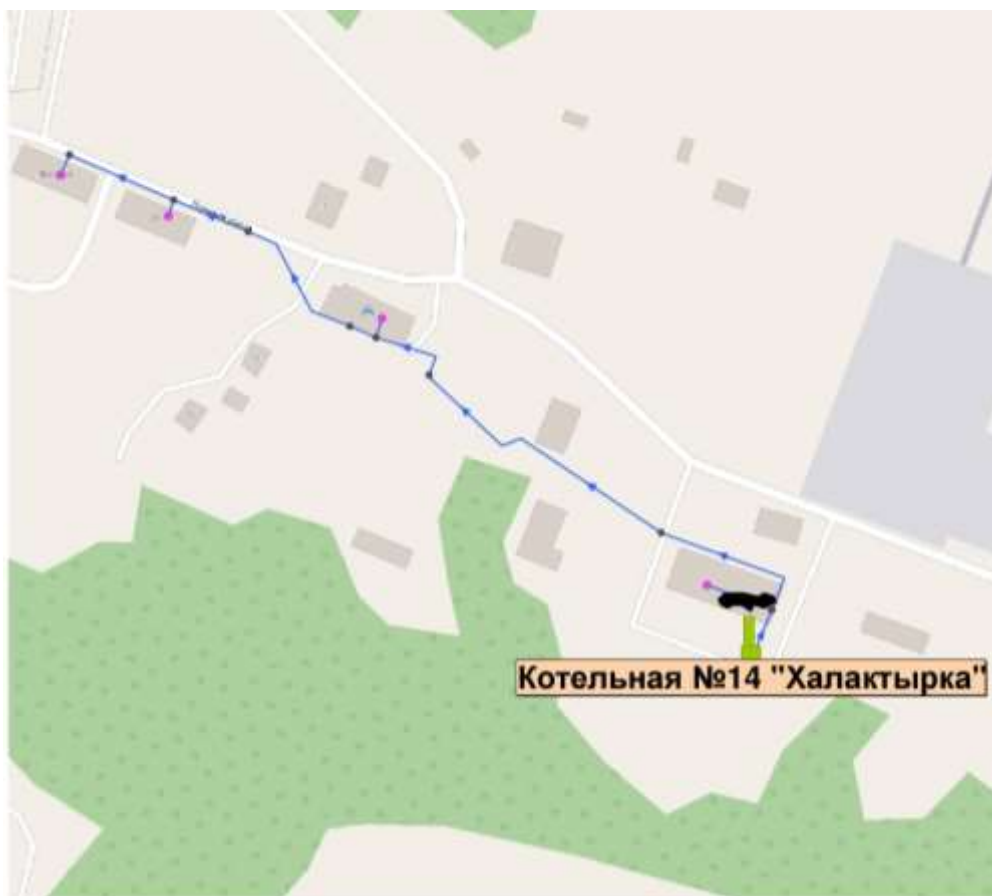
Схема тепловых сетей от котельной №14
